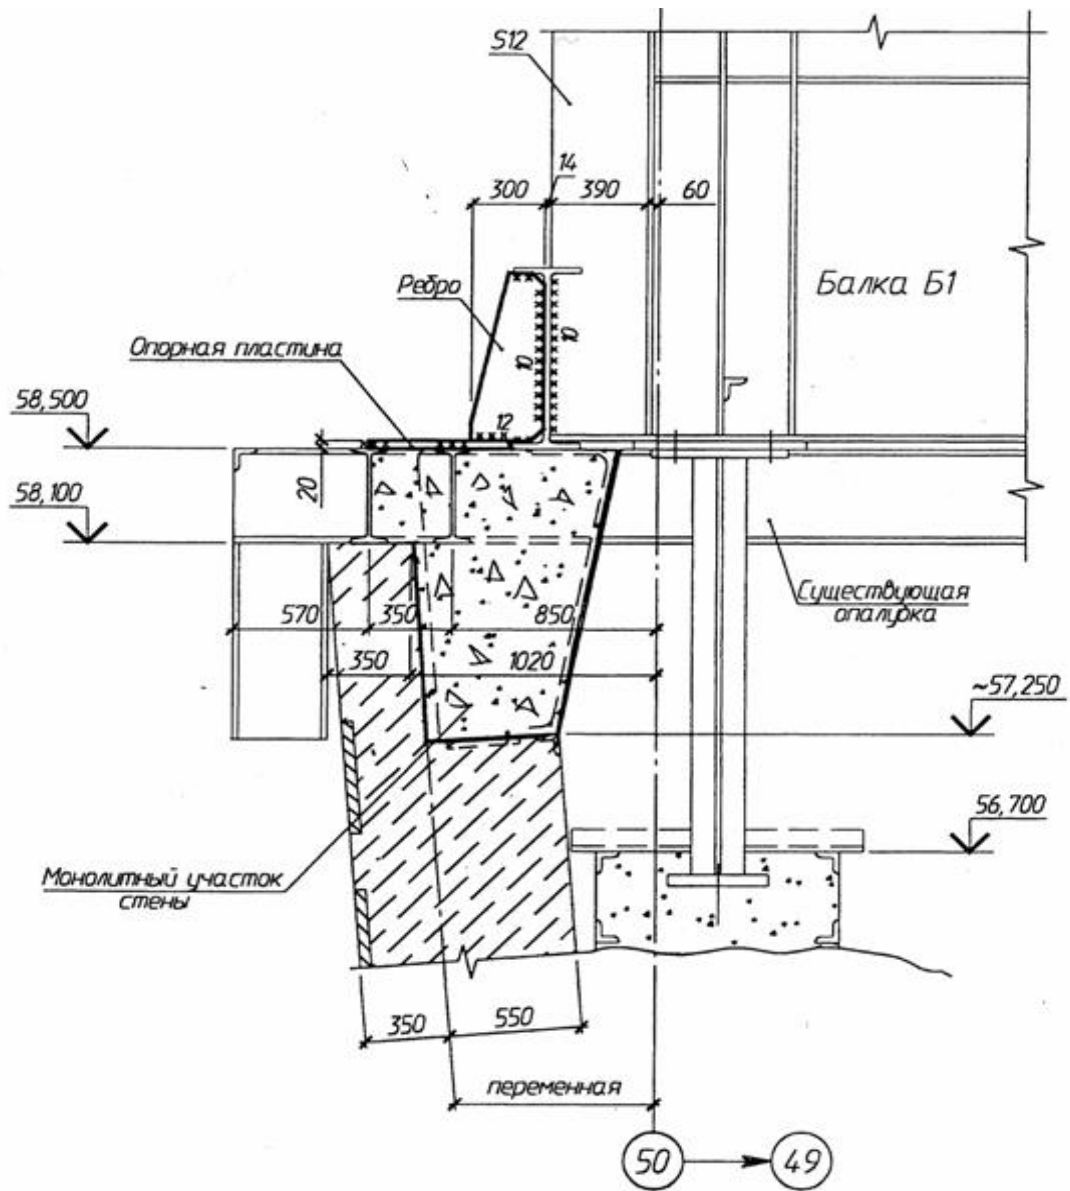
Усиление опорных частей балок Б1 и железобетонной стены по оси 50 в месте опирания на нее блока балок Б1 (ряд Ж).
